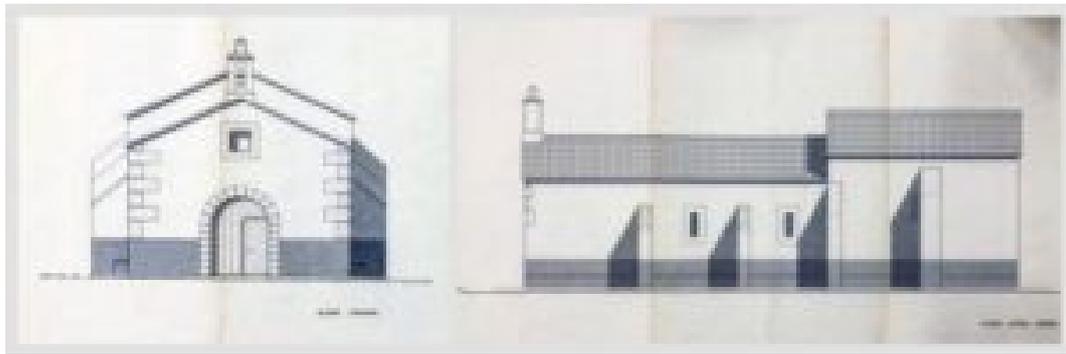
(a y b). Planos 10 y 11. Alzado principal y lateral derecho (reformados).
